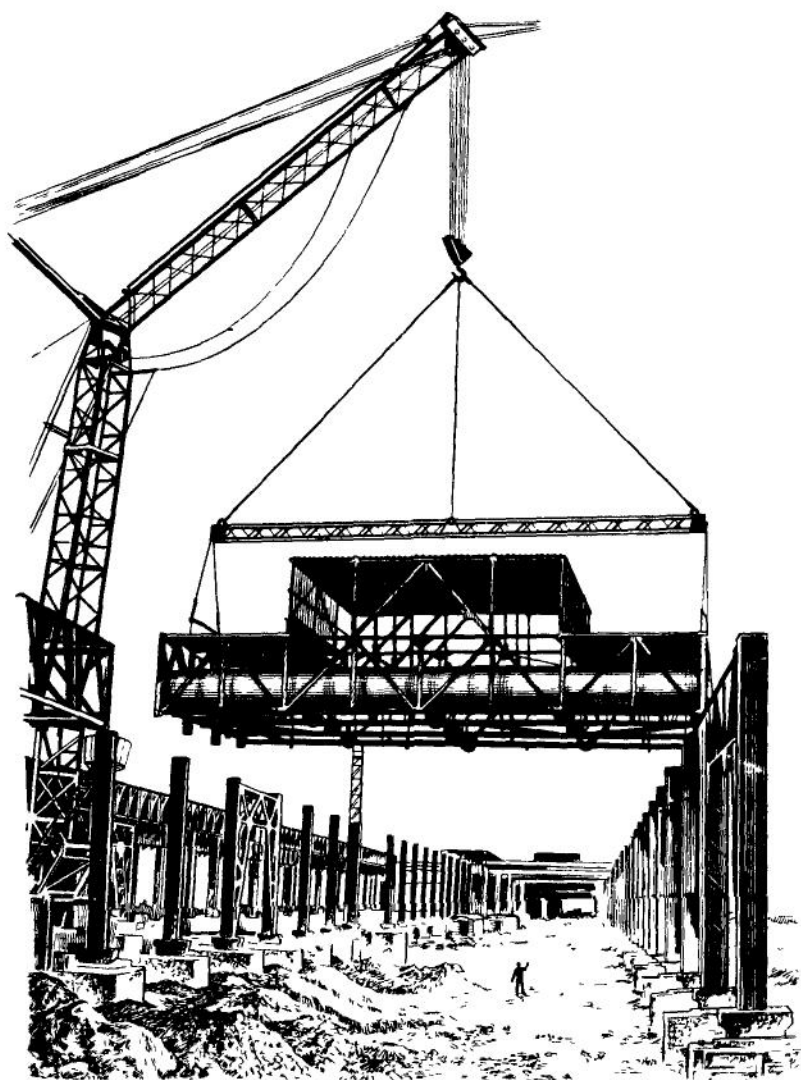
Установка блока покрытия с уложенным воздуховодом
